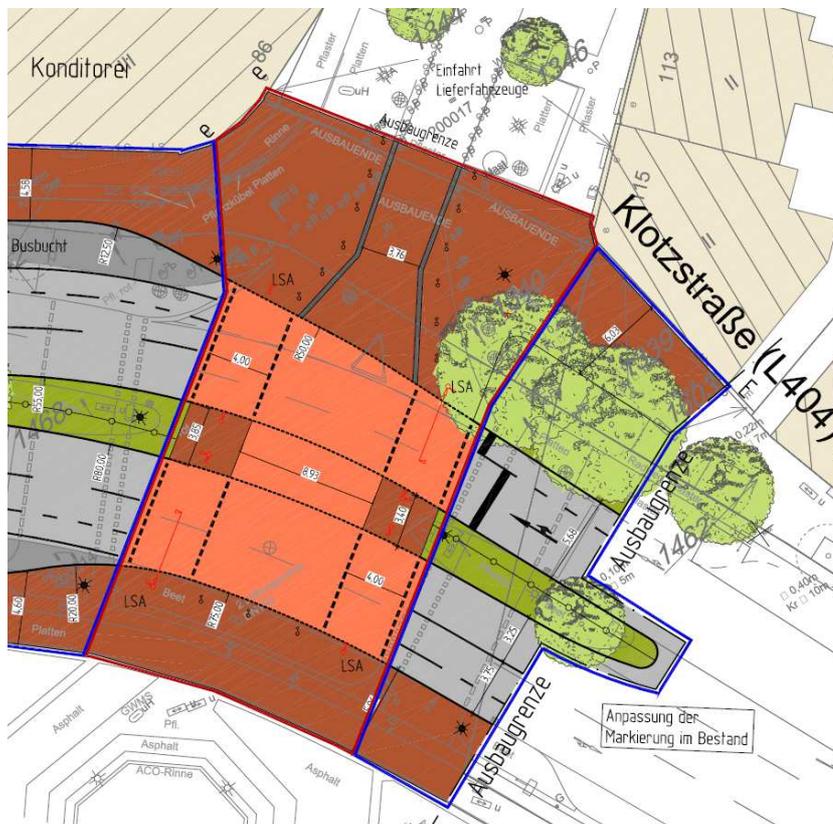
Ausschnitt aus der Planung, Übergang Mittelstraße
